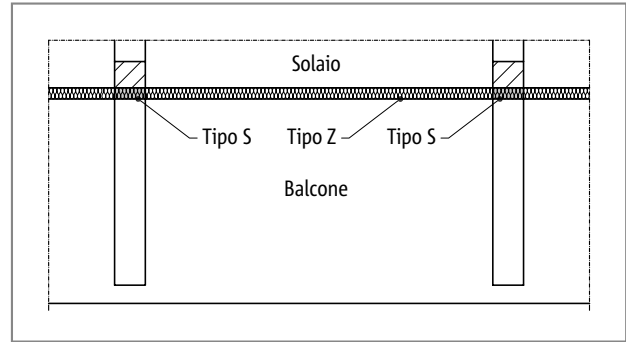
Schöck Isokorb® tipo S, balcone con travi a sbalzo
